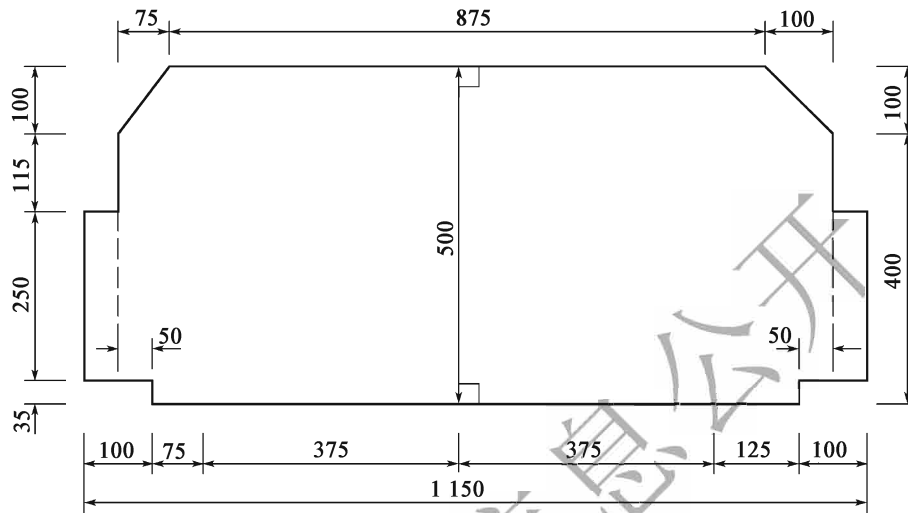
Dégagement de construction du tunnel autoroutier à deux voies(120km/h) (unité:cm)
